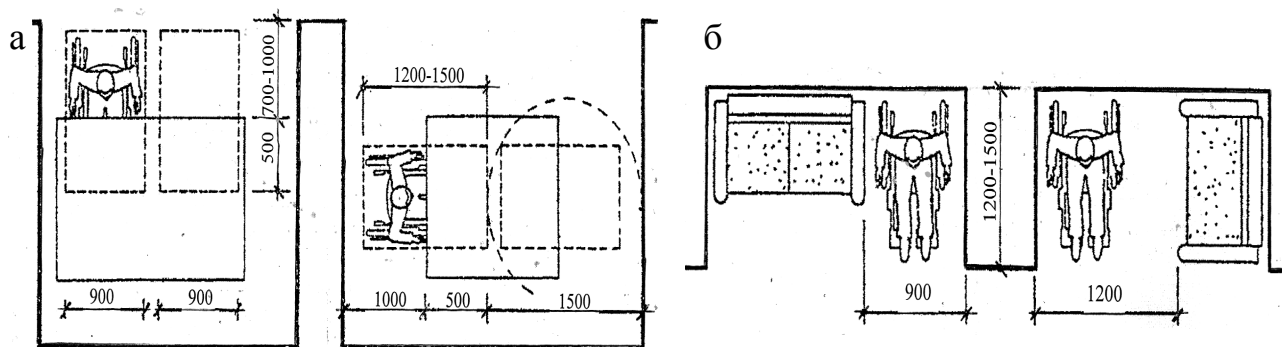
Примеры зон отдыха: а – площадки «карманы»; б – места отдыха с креслами
